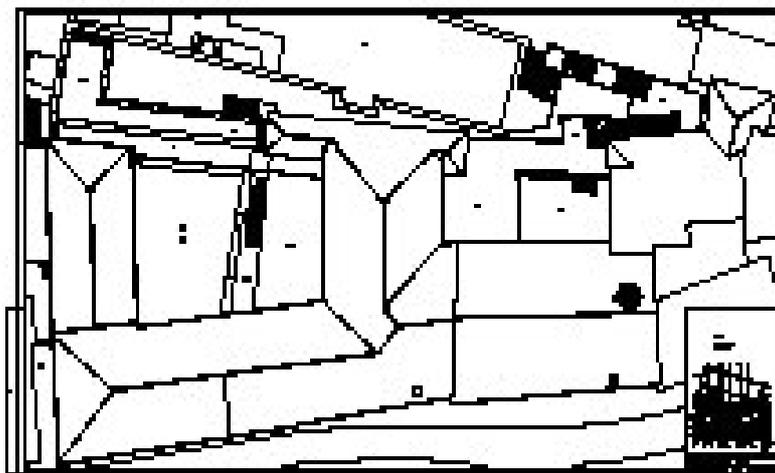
Planta da cobertura do imóvel Conde de Vilas Boas
